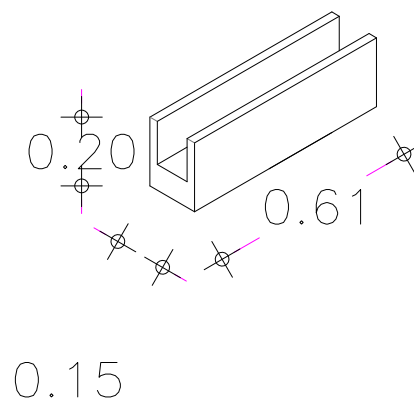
Detalle de los refuerzos verticales y horizontales en el muro "O", aplicando elementos de concreto celular.
